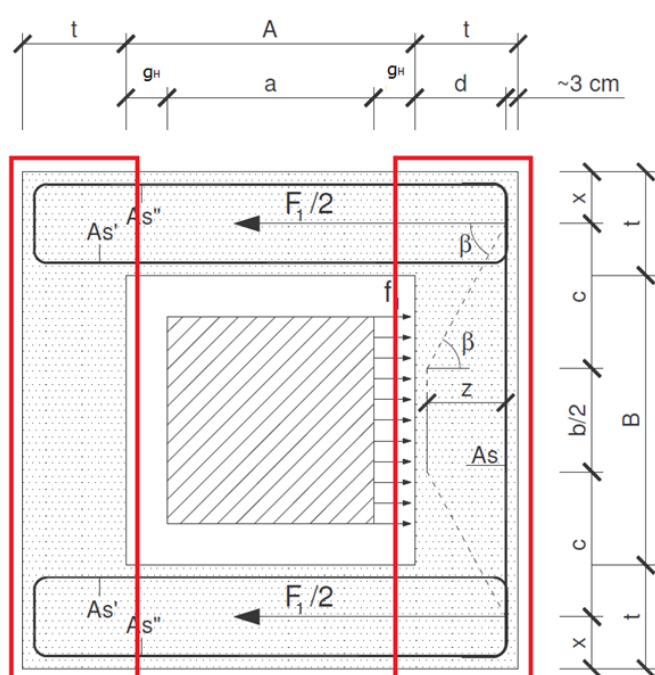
spallette oggetto di verifica lungo X con schema tirante-puntone
